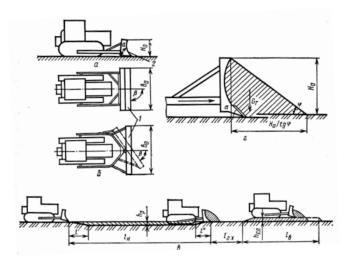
Схемы работы бульдозеров: a – с неповоротным отвалом; δ – с поворотным отвалом; ϵ – схема набора, перемещения и отсыпки грунта; ϵ – схема к определению объема грунта перед отвалом бульдозера
